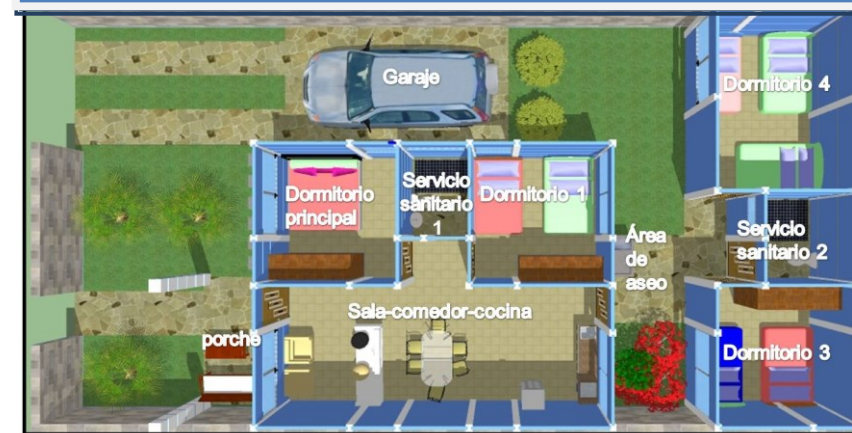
Vista planta arquitectónica del modelo de vivienda Verano, de la urbanización Valle verde en San Pedro de Lóvago, Chontales.
